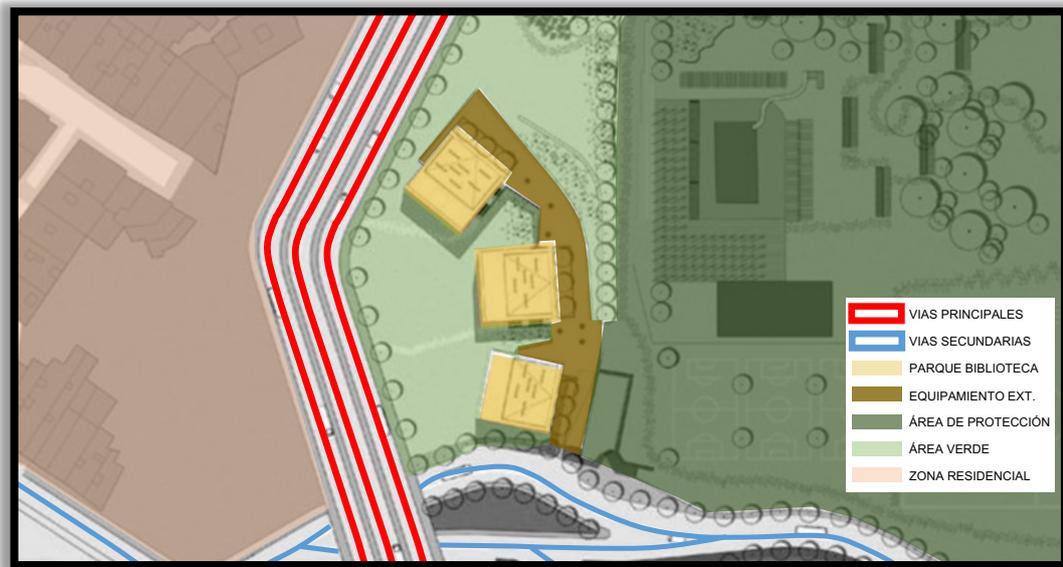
Plantas y cortes Parque Biblioteca León de Grieff
